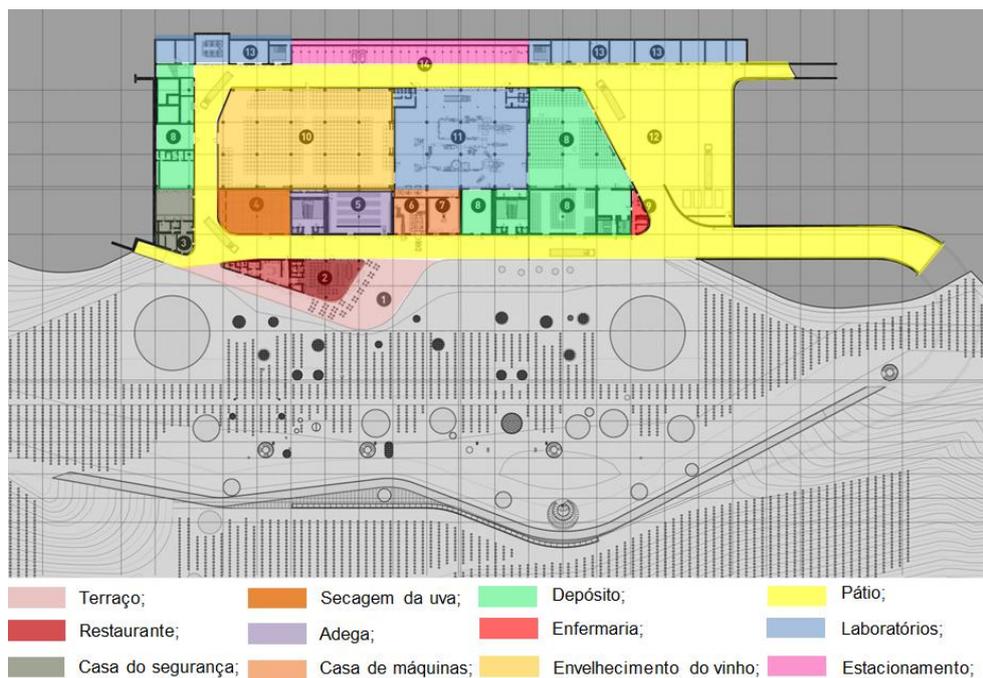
Fenda inferior | Planta baixa segundo pavimento
